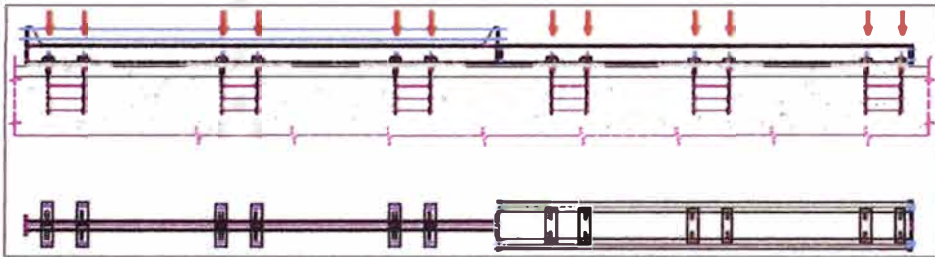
Vista elevación de colocación de anclajes de los carriles de avance.
